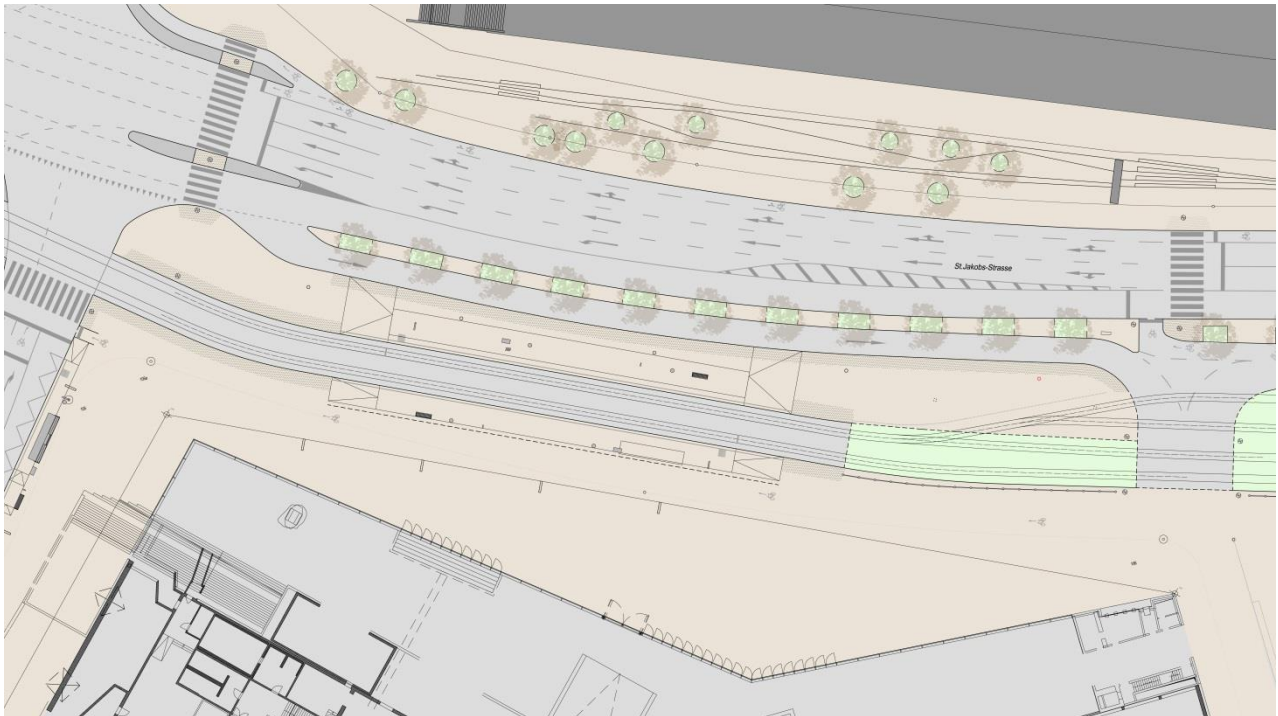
Tramhaltestelle St. Jakob projiziert mit neuem Platzbereich vor sanierter St. Jakobshalle
